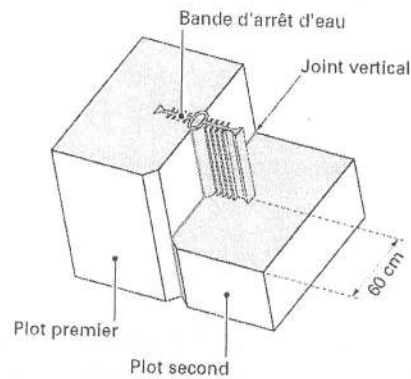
Installation d'un joint waterstop entre les plots du parement amont d'un barrage poids (Cognard, 2003)
